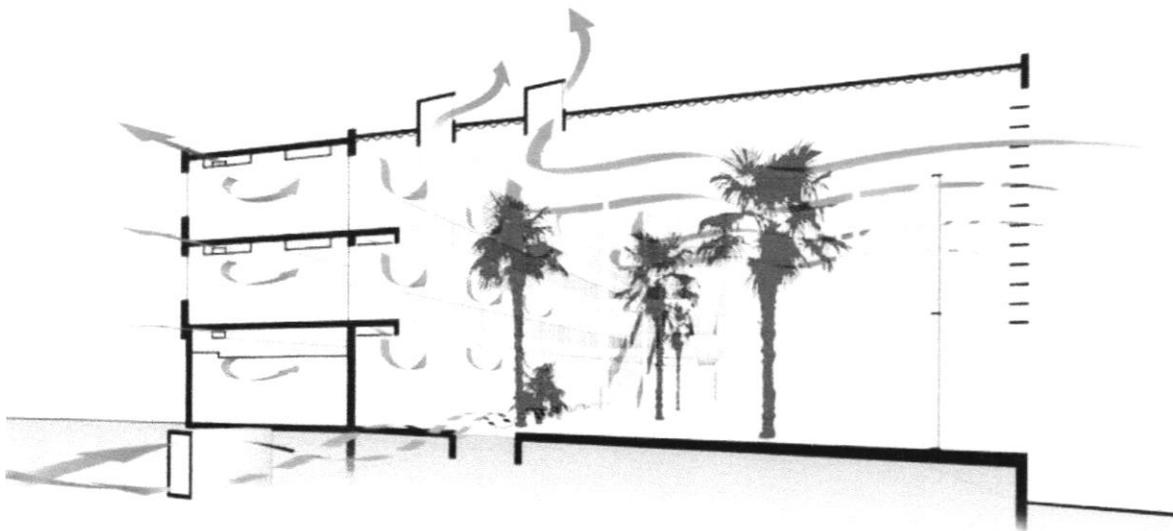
ventilation naturelle - coupe d'un centre commercial
